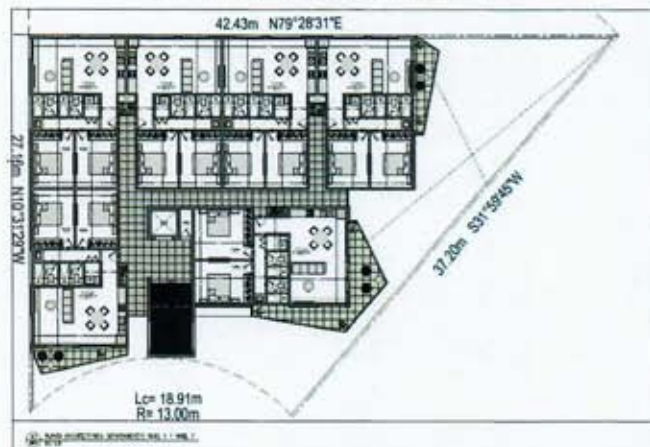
Planta tipo de uso habitacional (niveles 2 y 3).¹⁰¹
